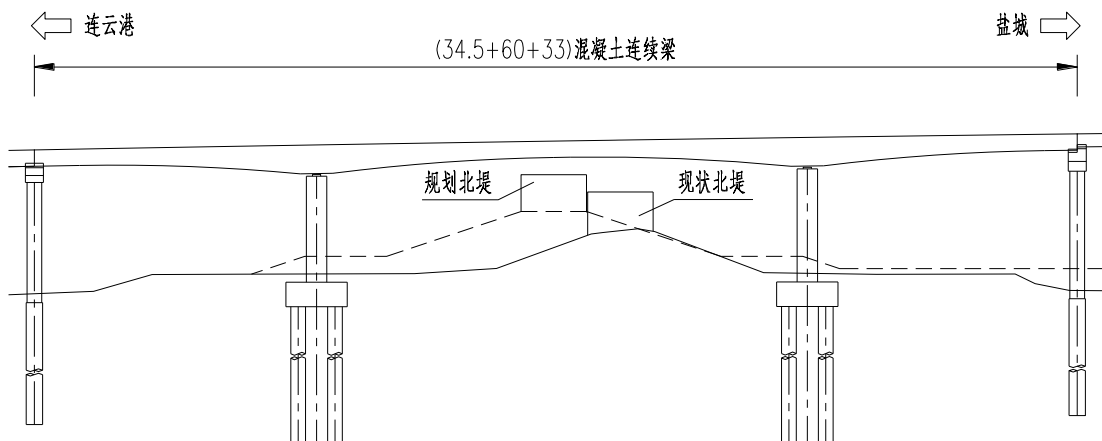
跨北堤桥梁桥跨布置图（单位：m）
